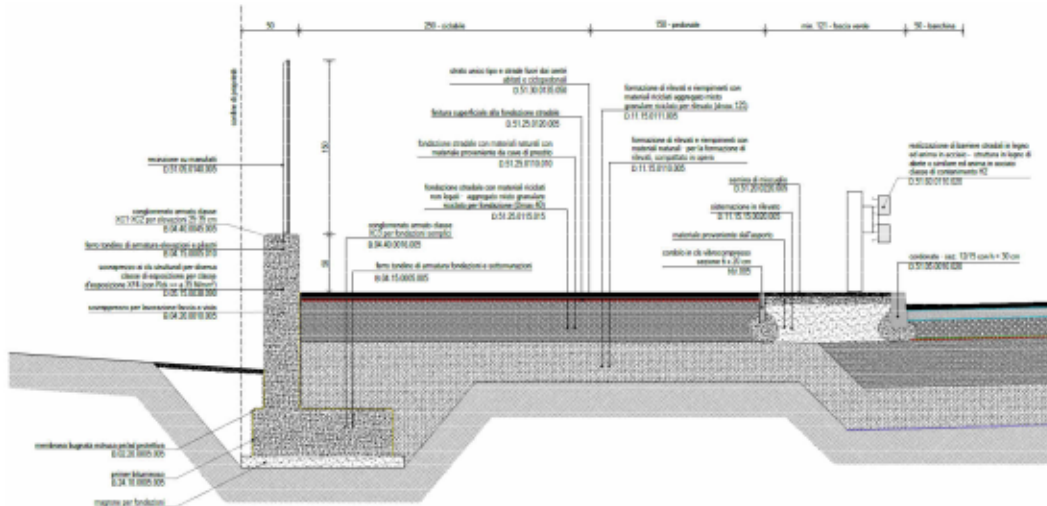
"Sezione 42 - muro tipologia 1 di progetto".
